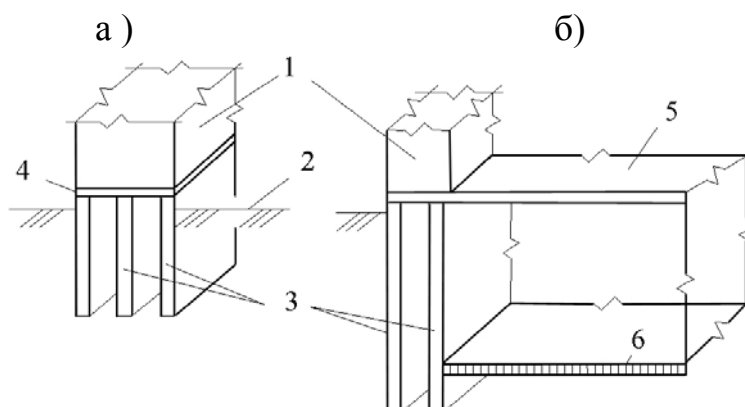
Многощелевые ленточные фундаменты:
